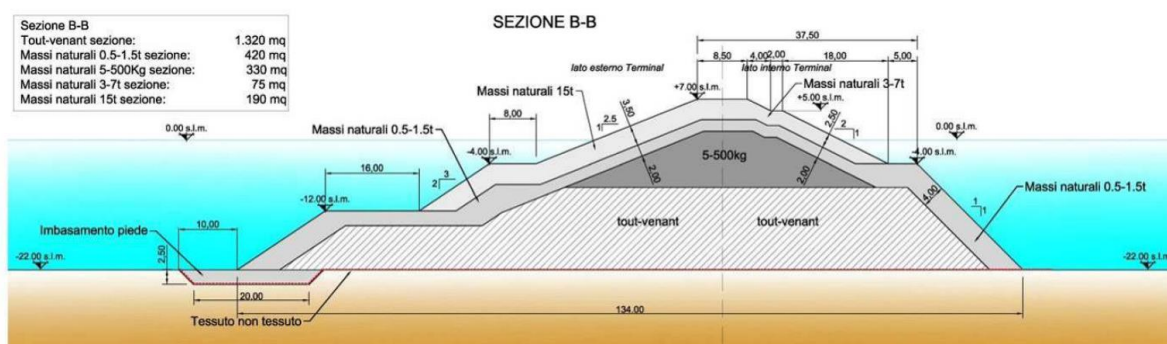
Dettaglio Sezione BB Diga Foranea
